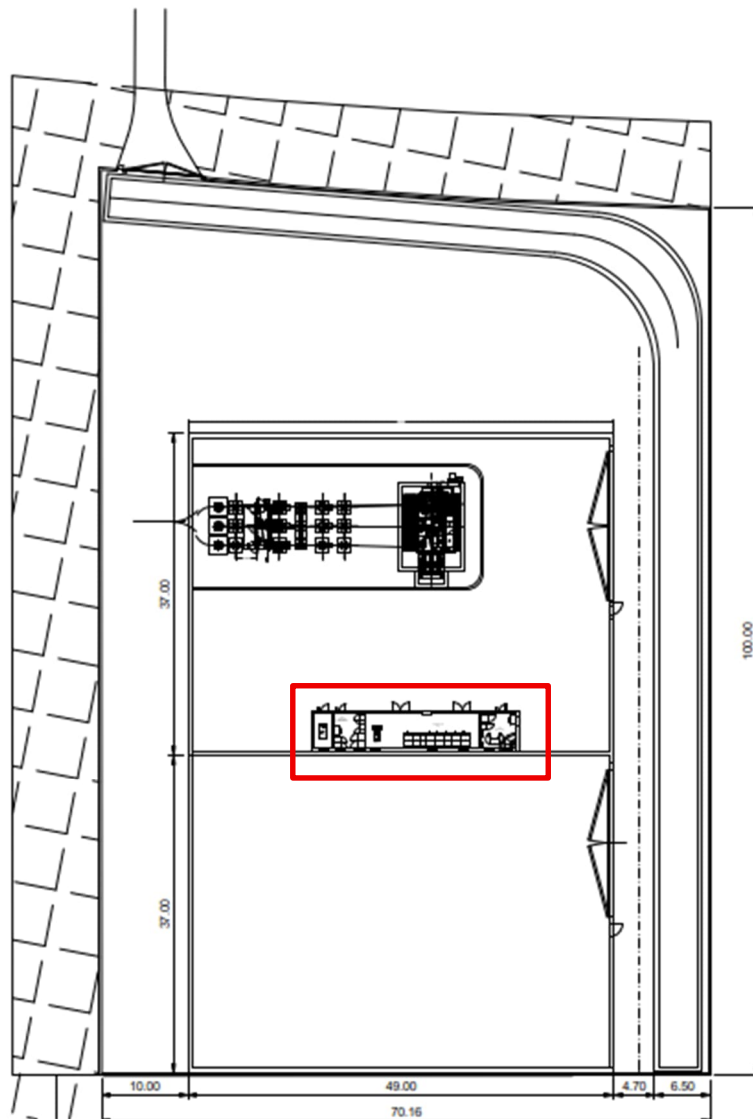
Planimetria della SEU con locale utente riquadrato in rosso
